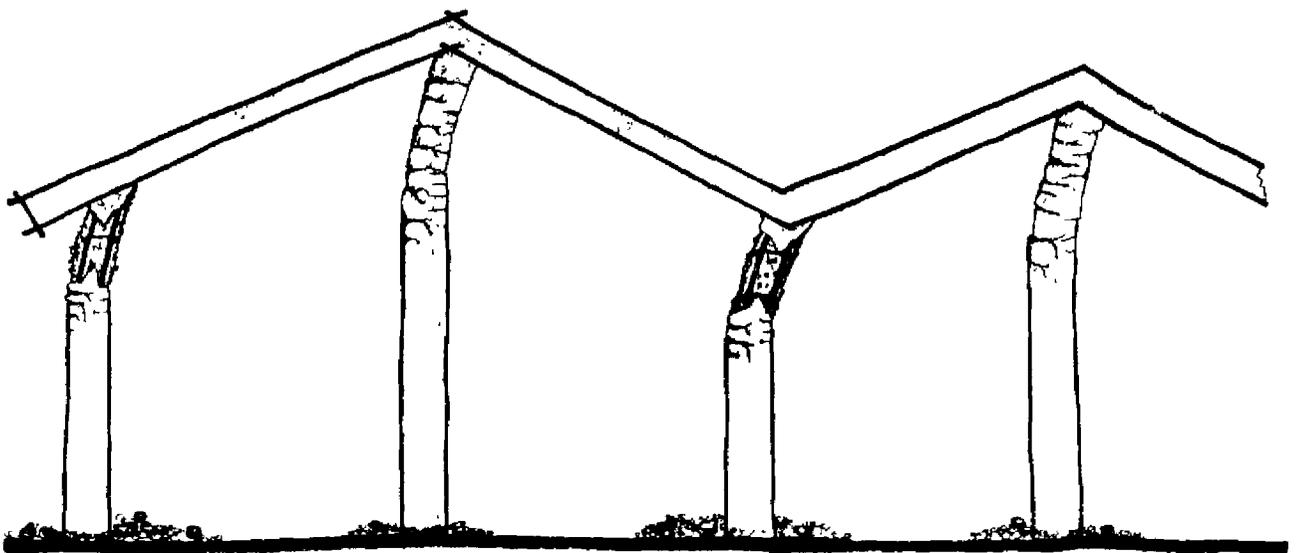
Columnas de menor altura y mayor rigidez en un espacio abierto de doble altura.
